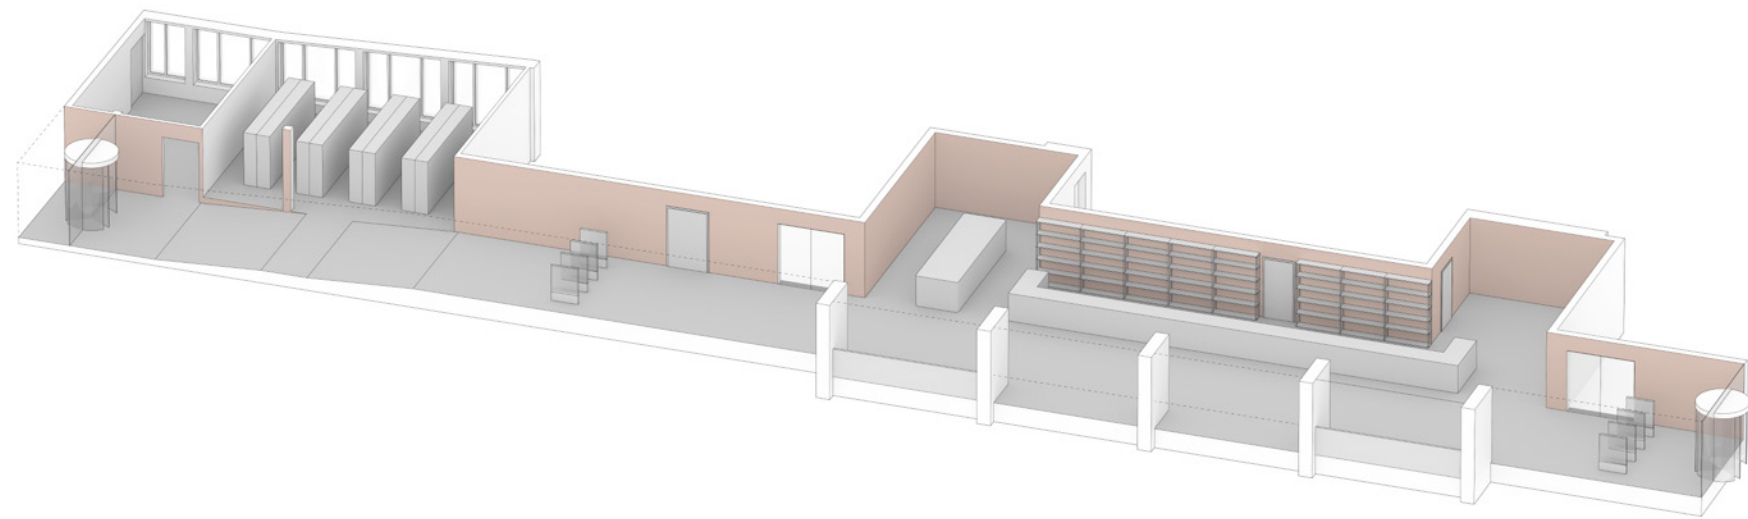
, oben: Markierung der Wandflächen/Marking of wall surfaces
